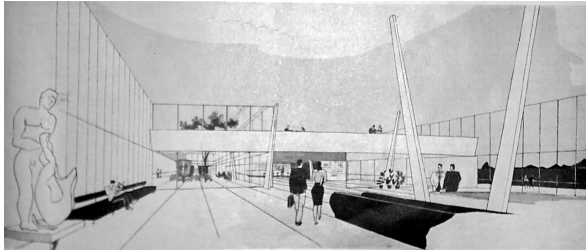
Vista do restaurante para a entrada do porto. Fonte: Revista Habitat, 1955.
